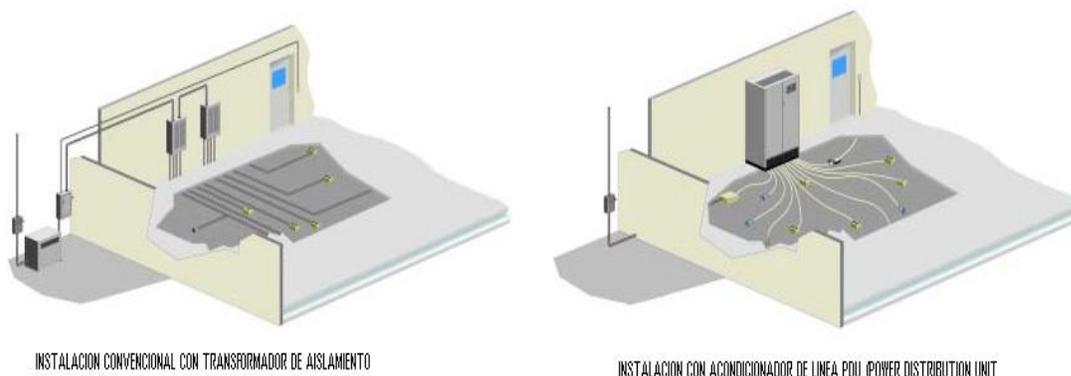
Misma instalación utilizando transformador de aislamiento y PDU
